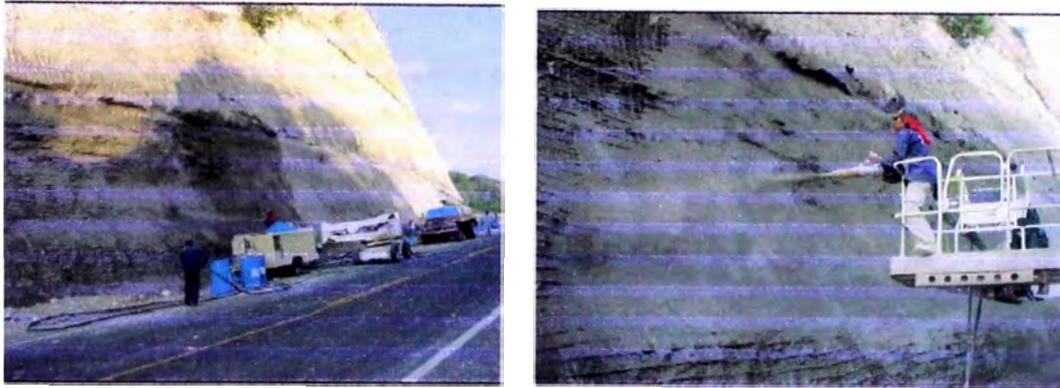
y 2.5 – Aplicación de Concreto Proyectado
